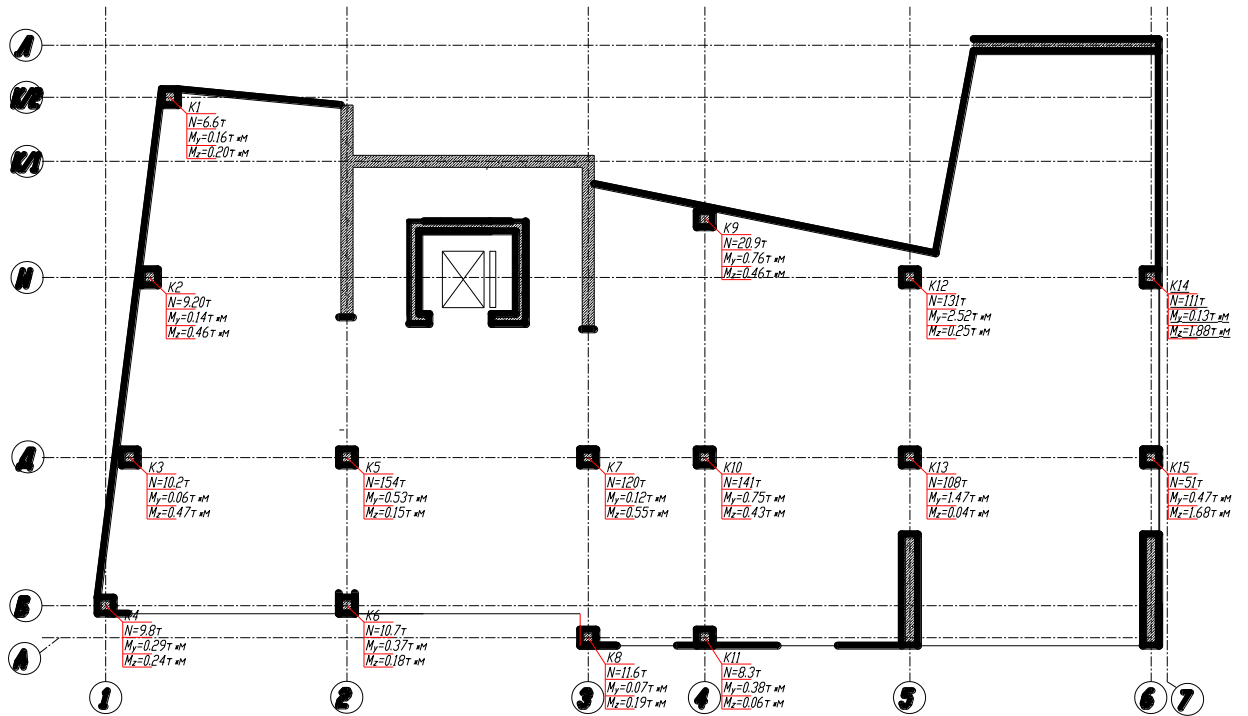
Навантаження на фундамент від РСН 2
